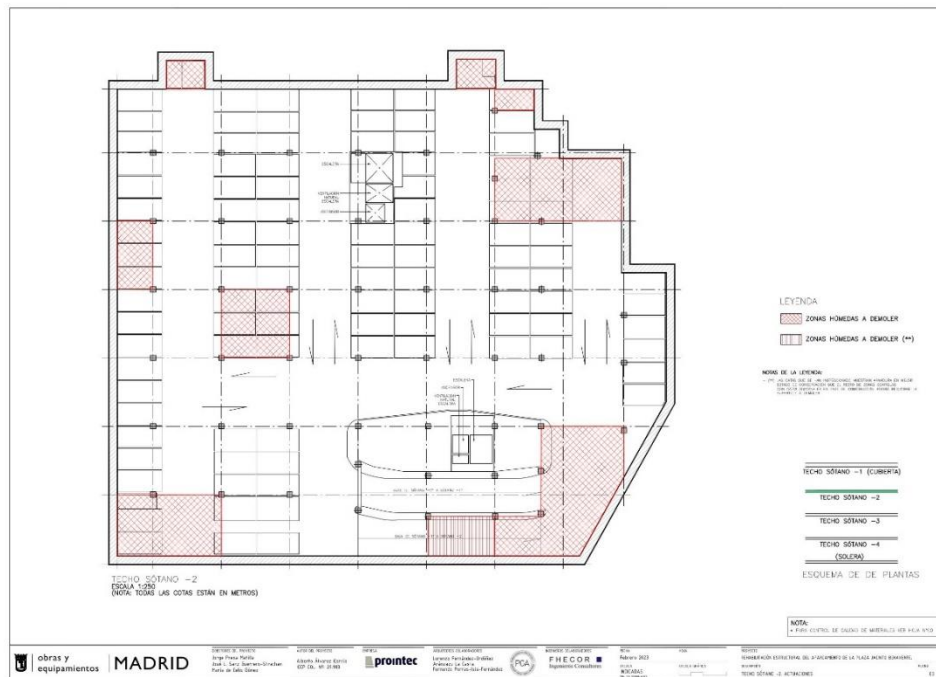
Plano Planta Sótano -1 que muestra las zonas confirmadas como húmedas, sombreadas en rojo
